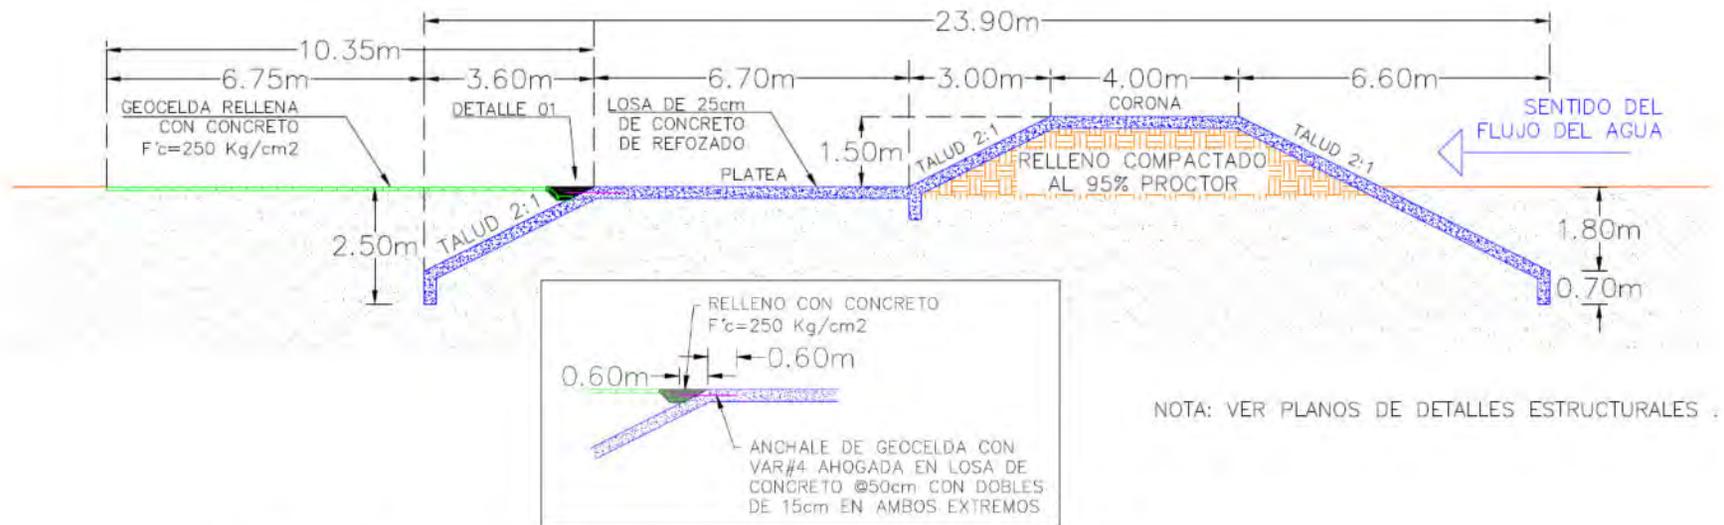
Sección hidráulica propuesta y detalles para el bordo Q1.
